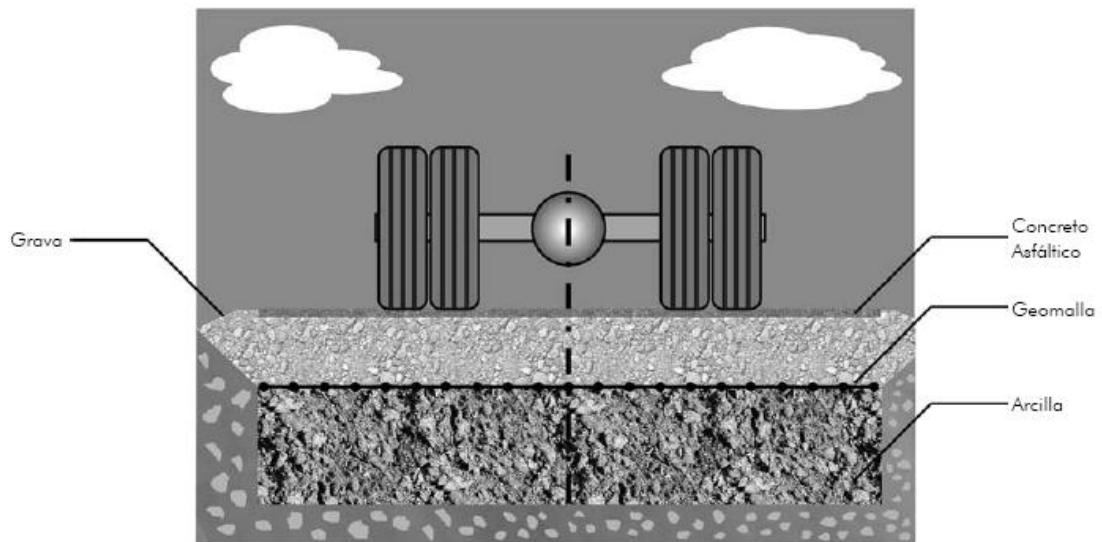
Vista en corte de la sección típica de la vía de ensayo.
